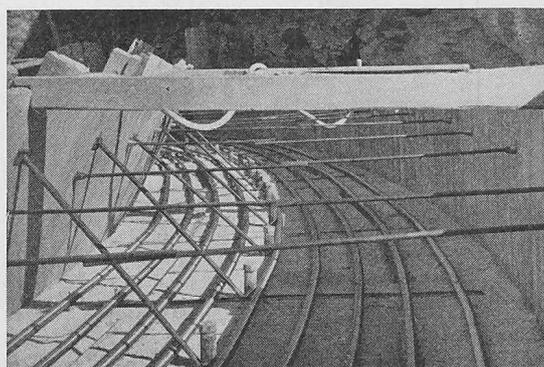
Câbles horizontaux avant le bétonnage, dans la zone du pied du barrage
